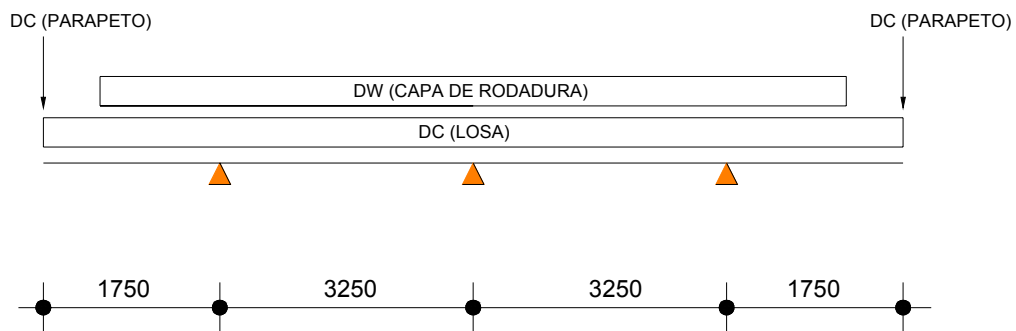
Esquema estructural para el cálculo de Carga Muerta en Voladizo y Tramos
